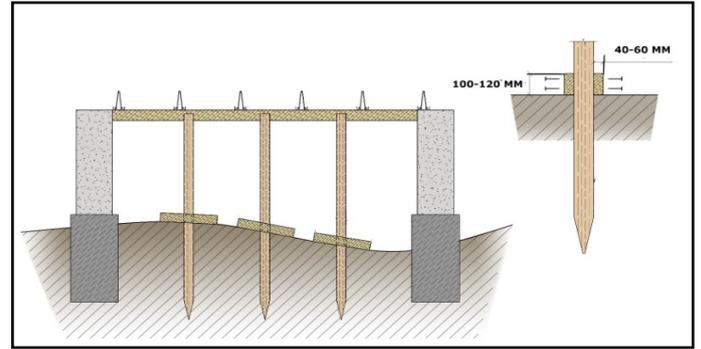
Схема устройства фиксирующей системы на слабонесущих грунтах
